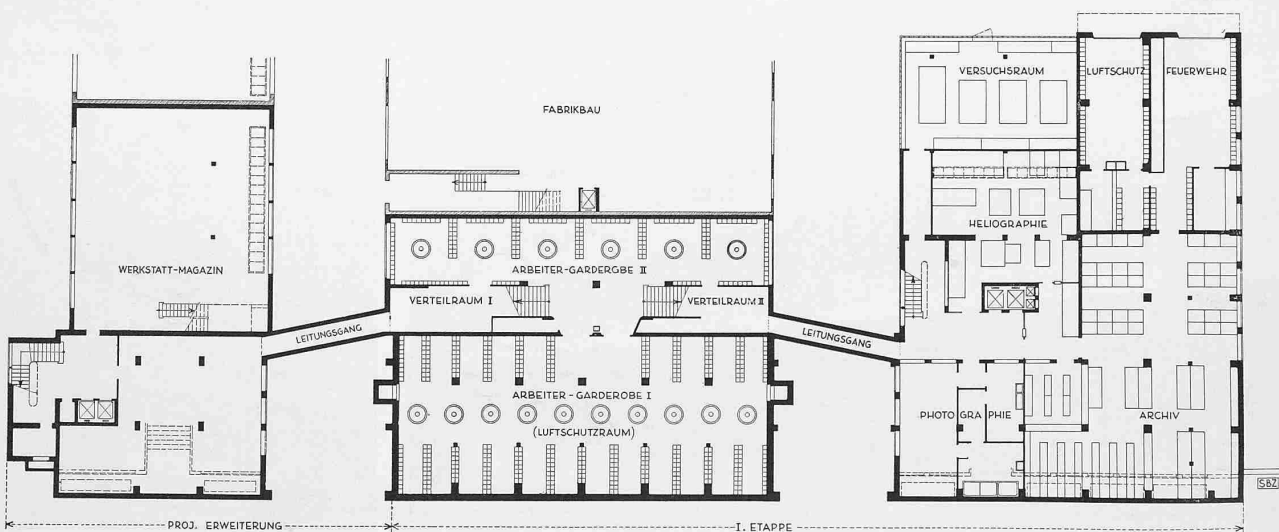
Grundriss vom Untergeschoss des ganzen Bureaugebäudes (ausgeführt ist z. Zt. nur die «I. Etappe»). — Masstab 1:500
